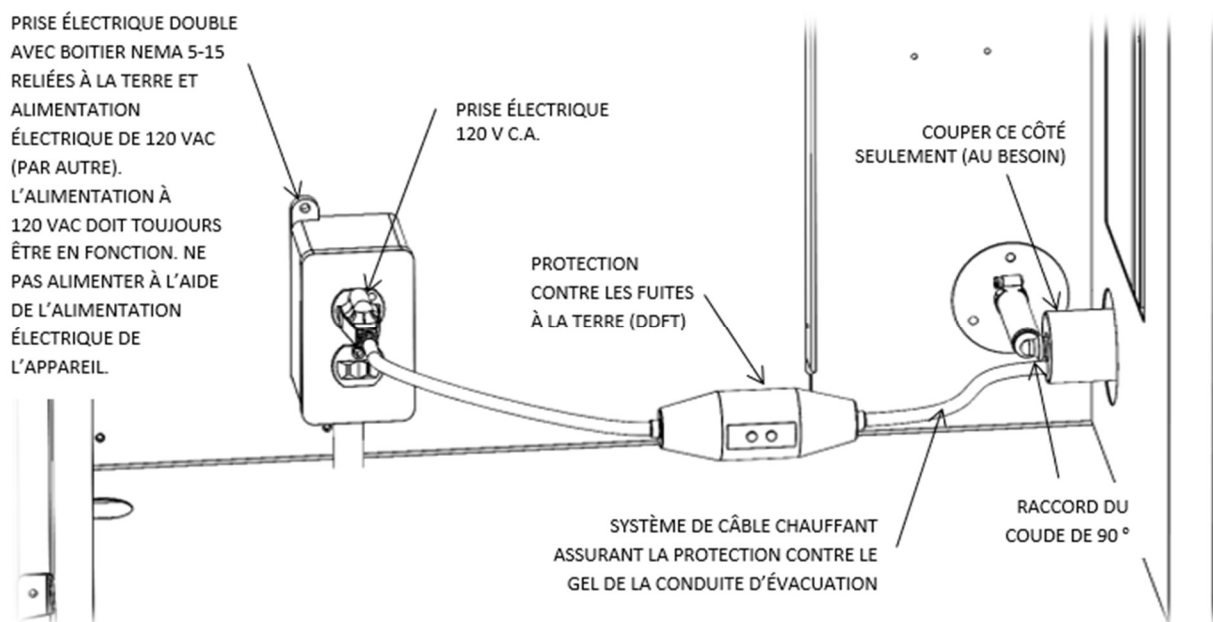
ASSEMBLAGE DE DRAINAGE CHAUFFANT TYPIQUE
